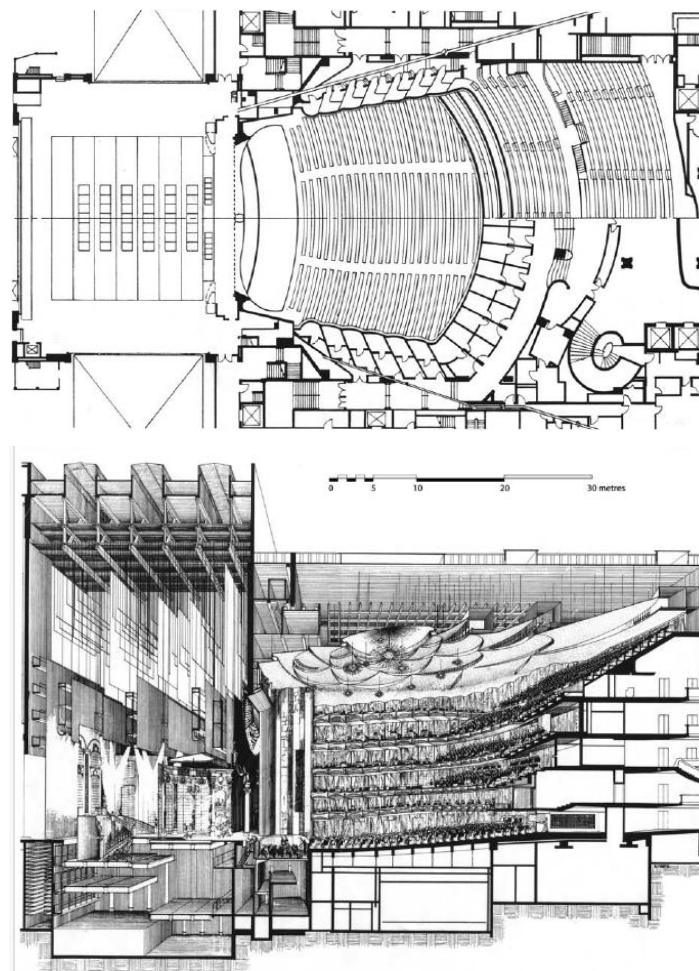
Planta e secção do Metropolitan Opera House, Nova Iorque [23]
